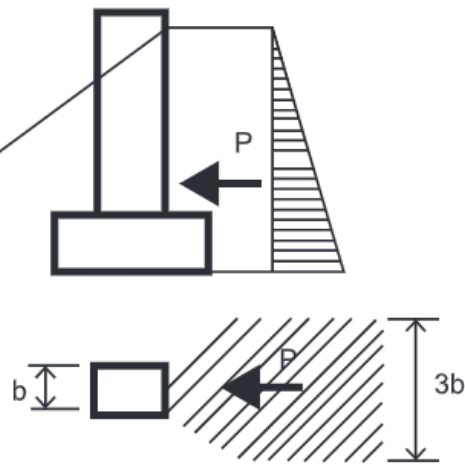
Empuje sobre elementos aislados. (NB1225002-1)
